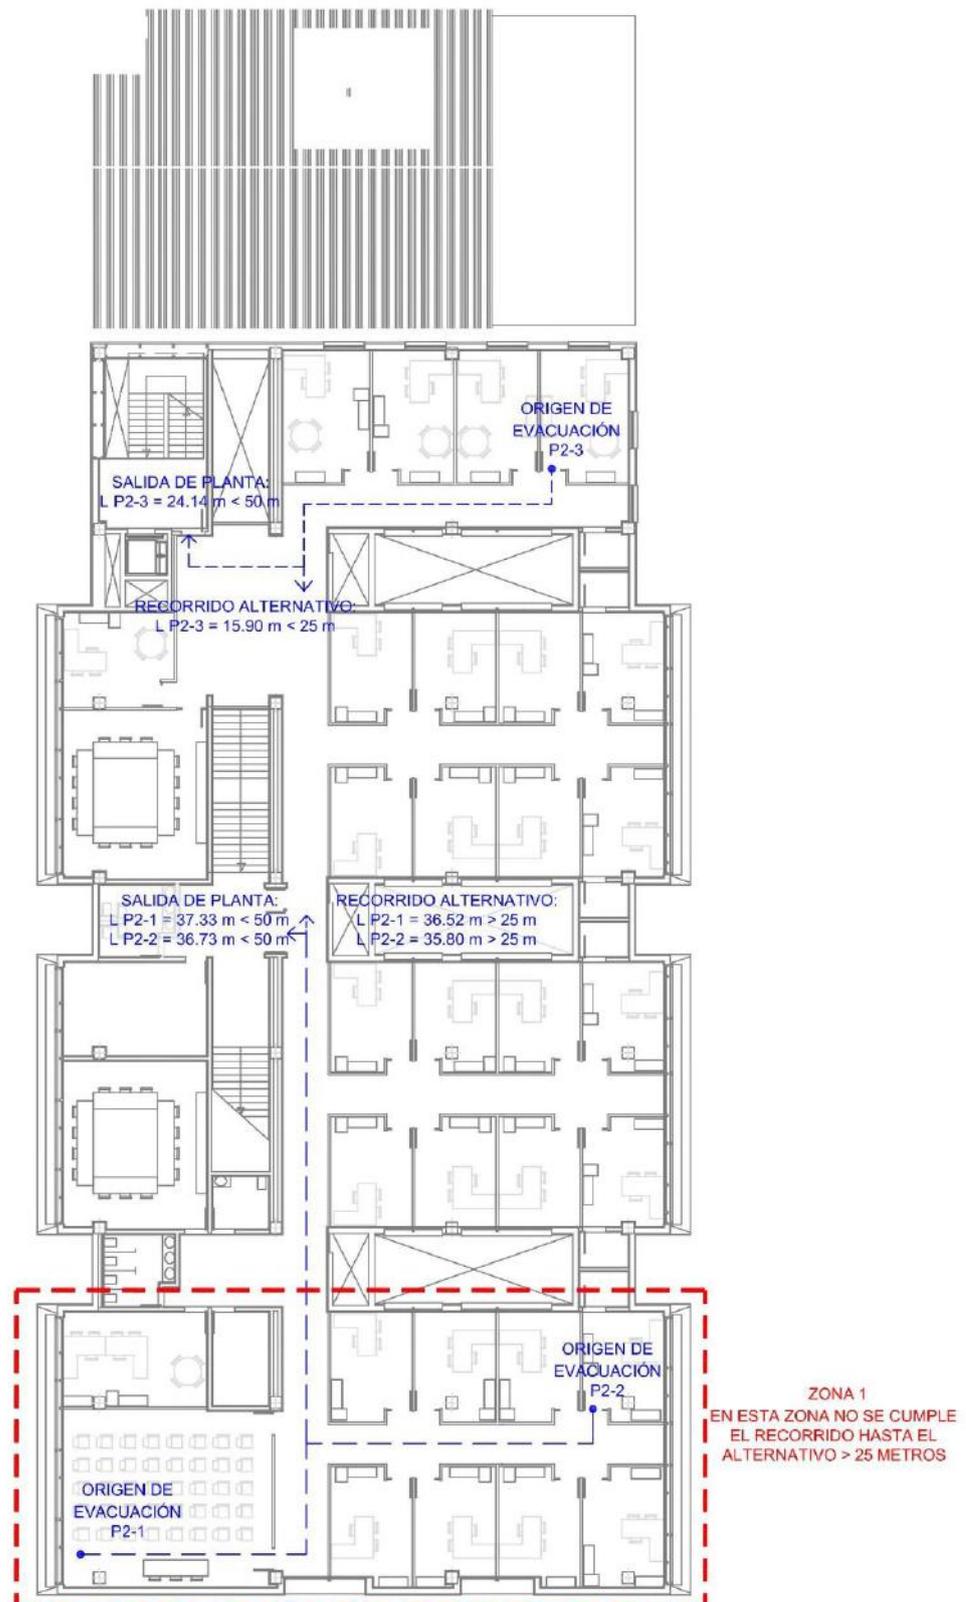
Cumplimiento Longitud Recorridos de Evacuación Planta Segunda. Figura extraída del plano 42.
